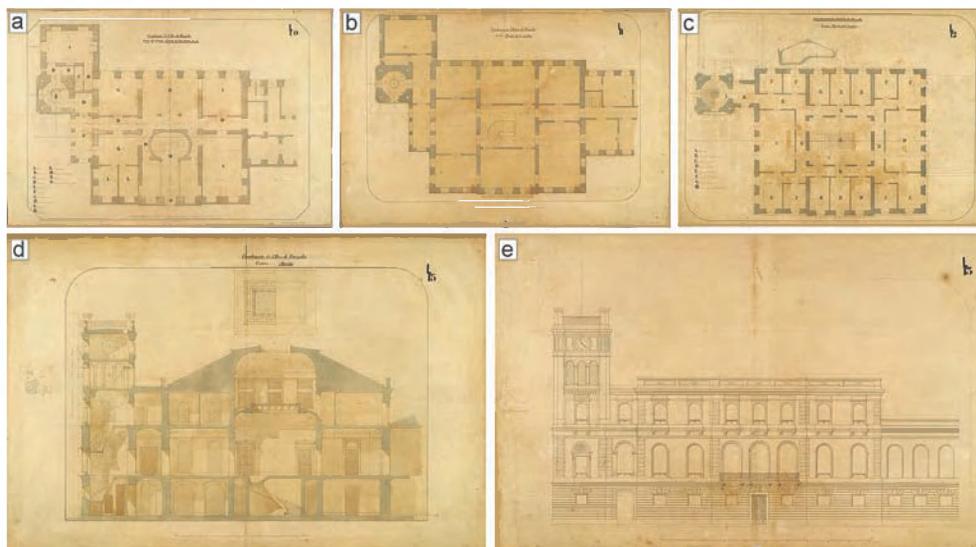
Projeto do corpo central do pavilhão de apoio ao Palácio Imperial: a. Planta baixa do pavimento térreo, 1861; b. Planta baixa do 1º pavimento, 1861; c. Planta baixa do 2º pavimento, 1861; d. Corte longitudinal, s/data; e. Fachada frontal, s/data.
